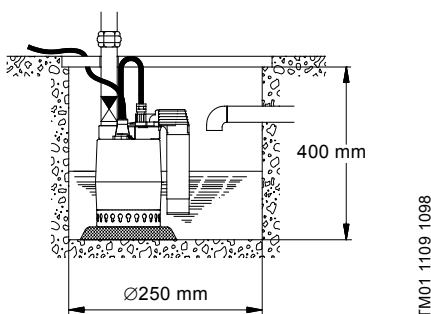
Dimensioni minime del serbatoio per la Unilift KP-AV
